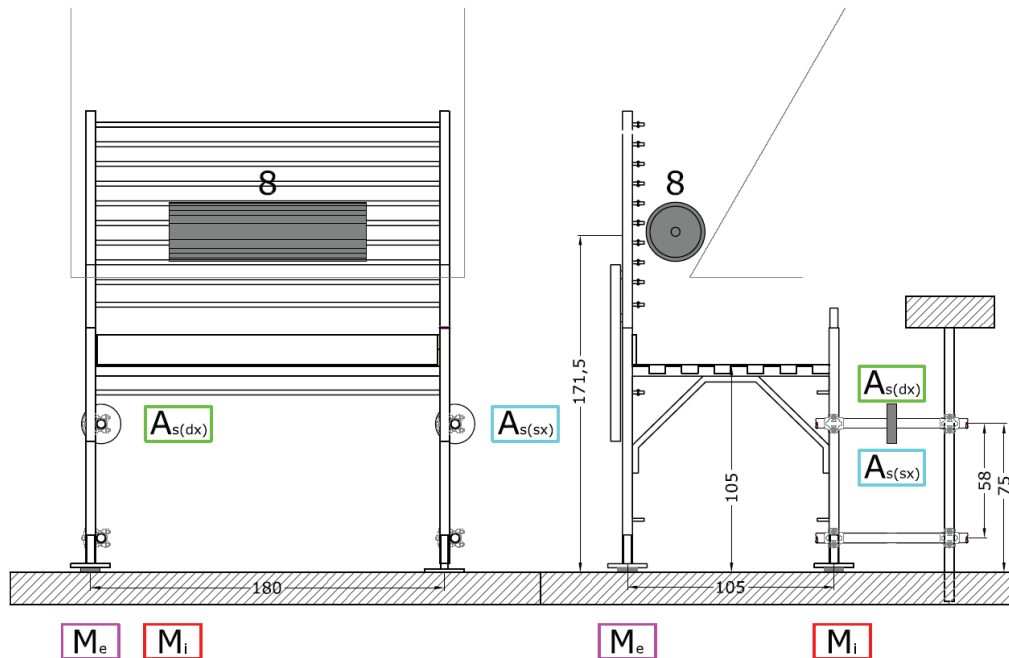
9 Prove d'impatto con rullo cilindrico su corrente intermedio – Schema CS2 – Posizione degli strumenti di misura
